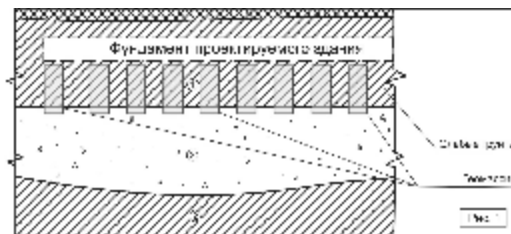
Схема закрепления грунтового основания грунтоцементными элементами
